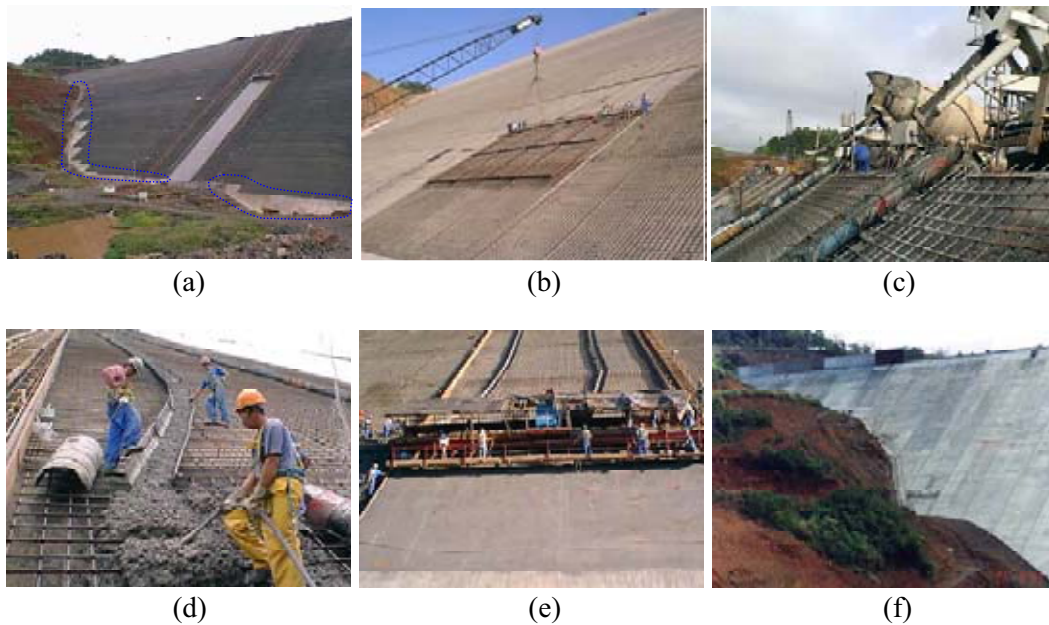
Seqüência construtiva da laje de concreto da face de montante: a) lajes de arranque; b) disposição da armadura; c) lançamento do concreto; d) adensamento do concreto; e) elevação da fôrma deslizante; f) laje acabada.
